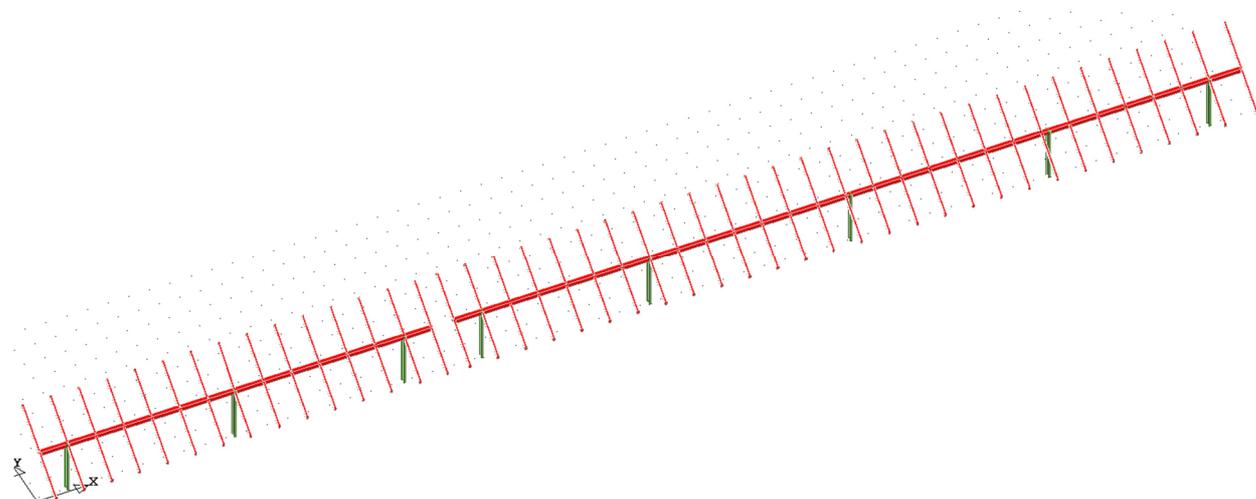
Vista assonometrica modello strutturale con posizione della “vele” inclinata di 55°
